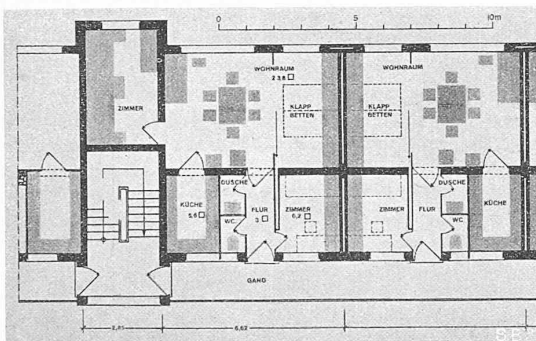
Grundrisse 1:250. — Der Aussengang zu den Treppenhäusern verläuft längs der Strassenseite.
